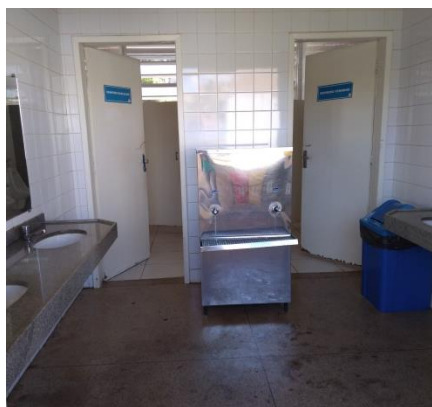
Vista geral do banheiro do 2º Pavimento com identificação das portas.
